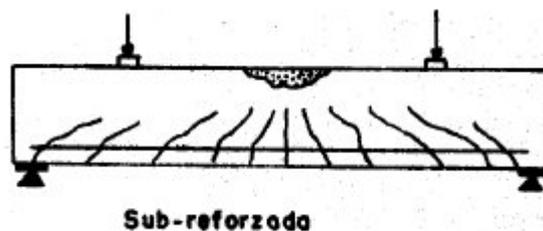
Falla de viga sub-reforzada (Civilgeeks, 2011)
